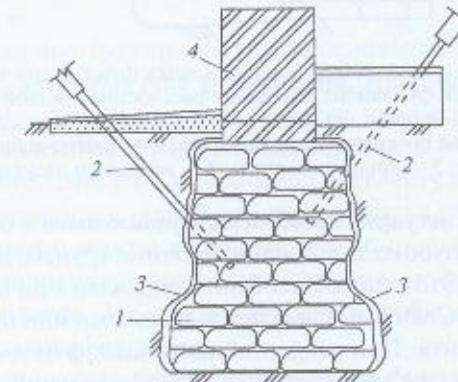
Закрепление бутовой (кирпичной) кладки фундамента цементацией и силикатно-полизицнанитным раствором:
